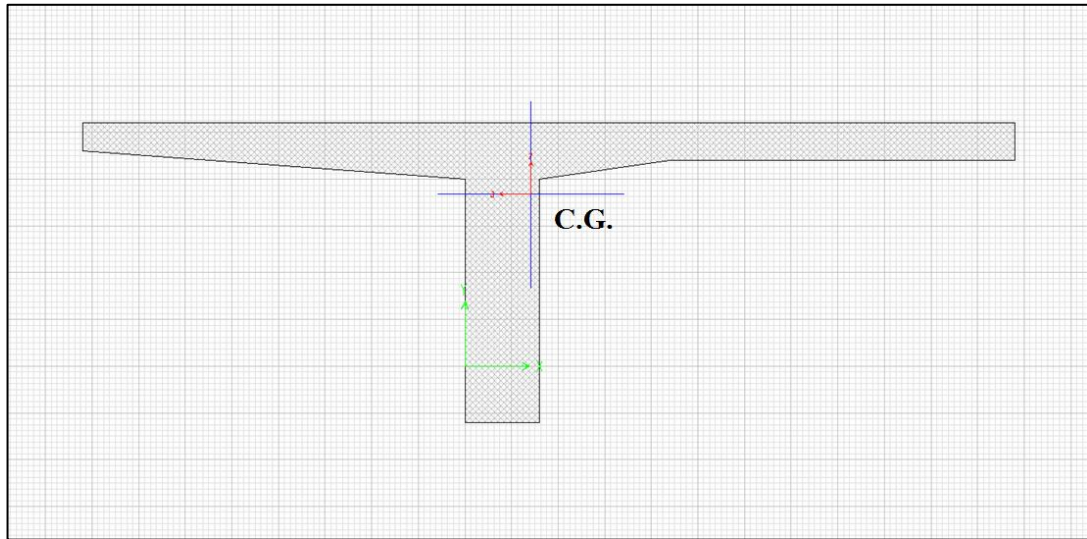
CASO 1 - Seção transversal da viga esquerda, equivalente à metade da seção transversal do tabuleiro. (SAP-2000)
